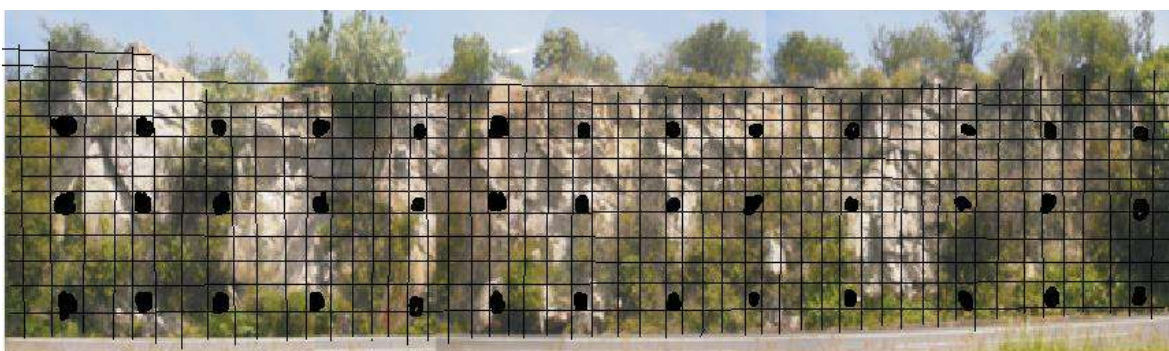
Refuerzo de malla de triple torsión con anclajes pasivos, para el talud 1 lado Oeste.
